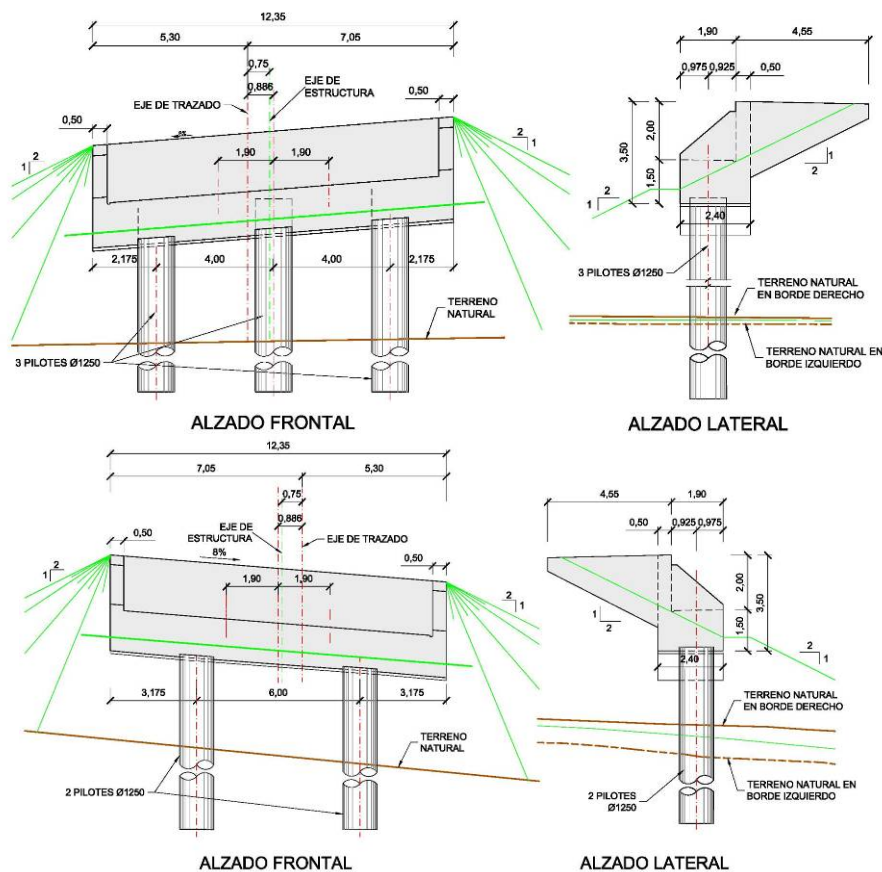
Alzados frontales y laterales de los estribos E1 y E2
